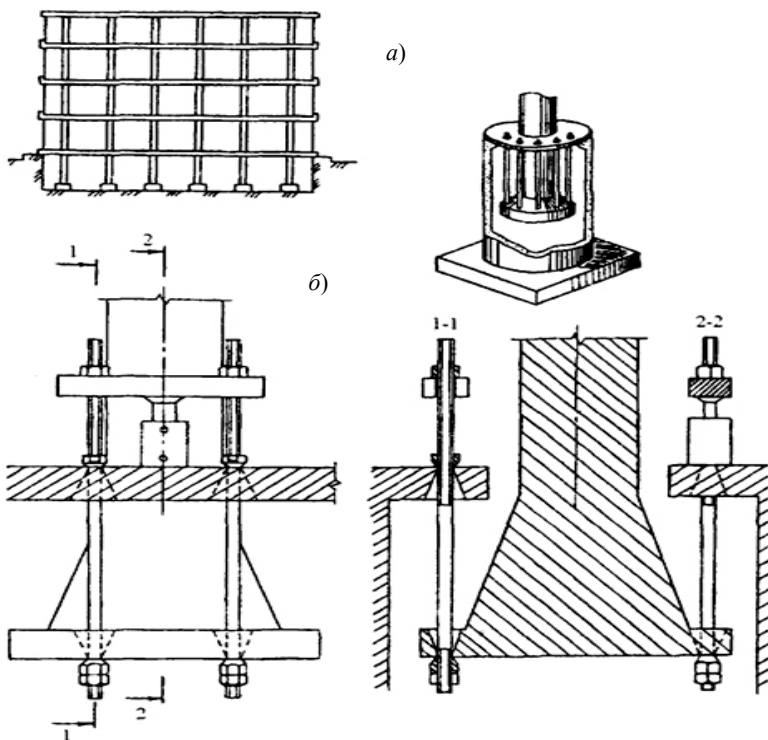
Варианты конструкции фундаментов на тьяжах:
